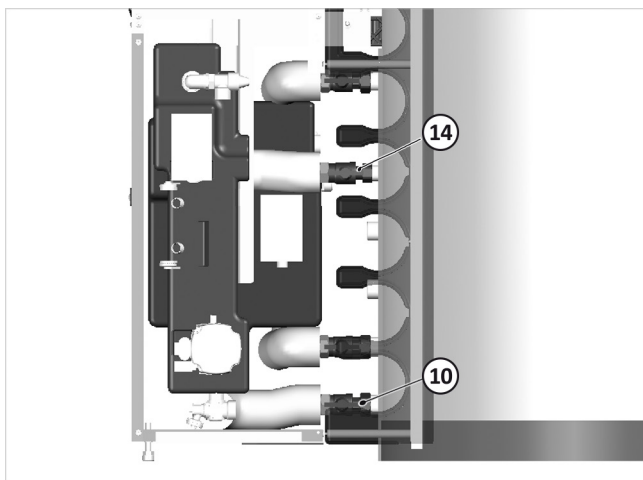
Zonnewarmte-overdrachtstation geplaatst (zonder deksel)
